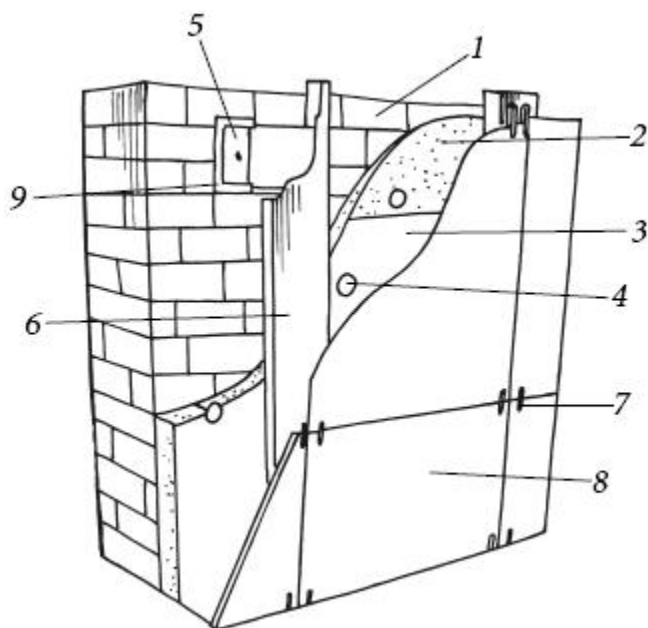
Общая схема навесного вентилируемого фасада: 1) стена; 2) плиты утеплителя; 3) гидроизоляционное покрытие на теплоизоляционных плитах (пароизоляция); 4) дюбели для крепления плит утеплителя; 5) кронштейн для крепления направляющих; 6) вертикальный направляющий профиль; 7) клипсы; 8) плиты облицовки; 9) резиновая прокладка-уплотнитель с функцией пароизоляции
